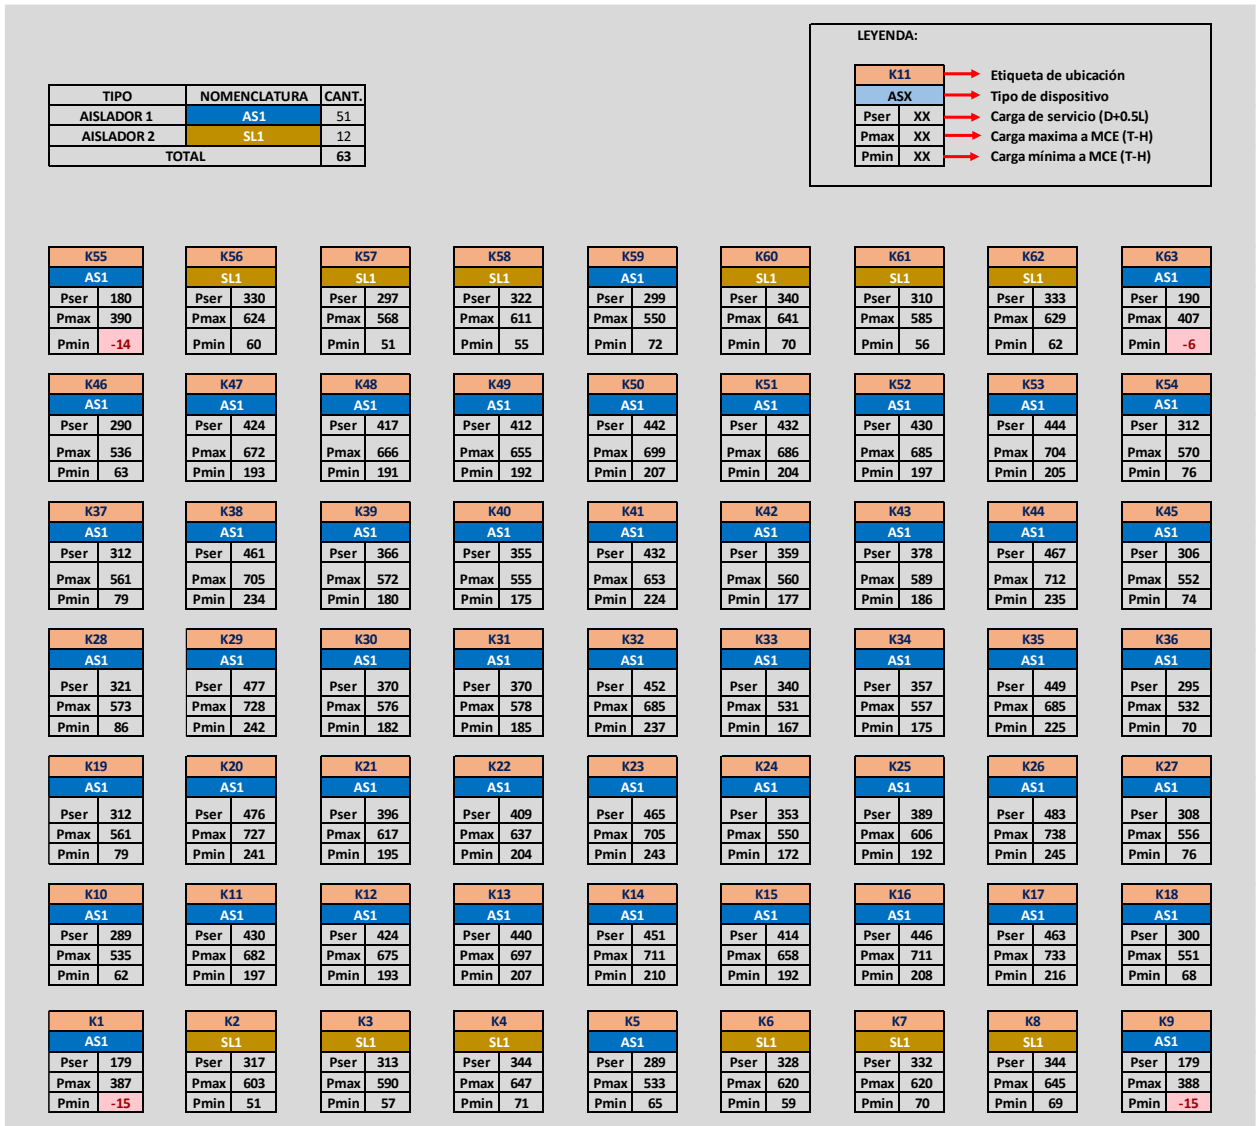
“Esquema de distribución en planta de dispositivos”
